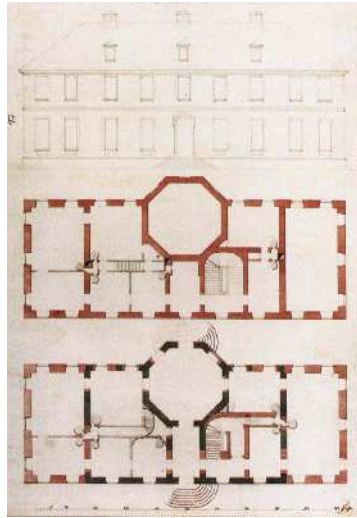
Ansicht und Grundrisse des Wallmodenschlosses, nicht signiert und undatiert (wahrscheinlich 1779) (NdrsHStaaA-H: Mappe 50, Bl.17)
